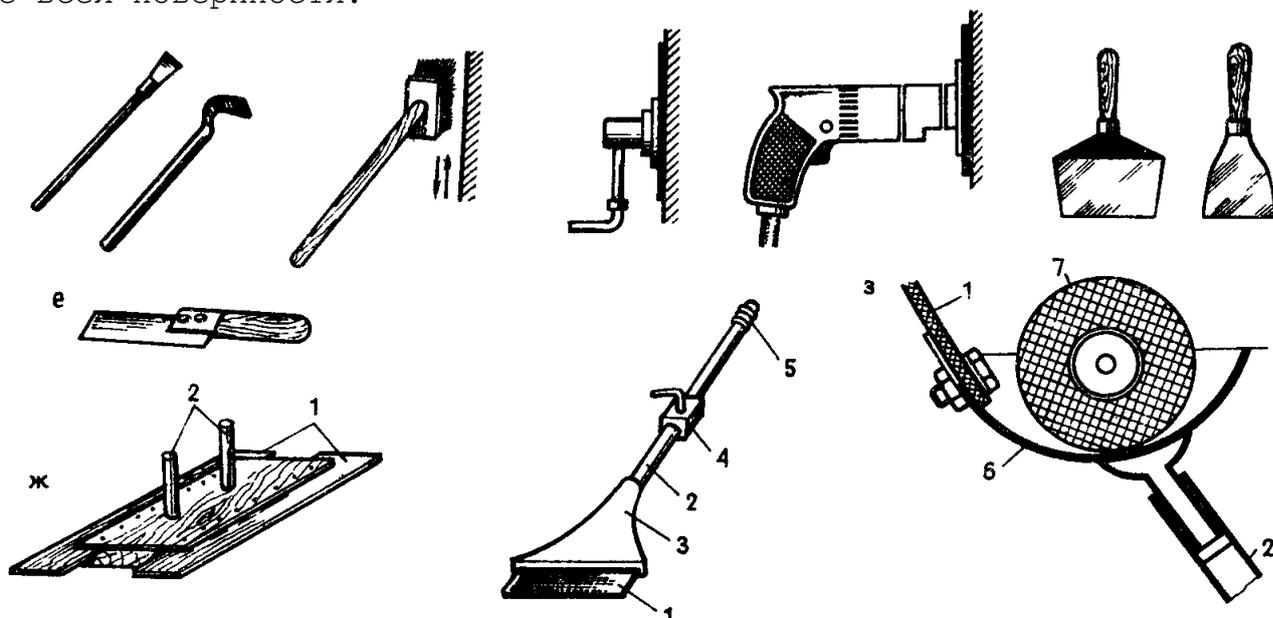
Инструмент для подготовки поверхностей под окраску
